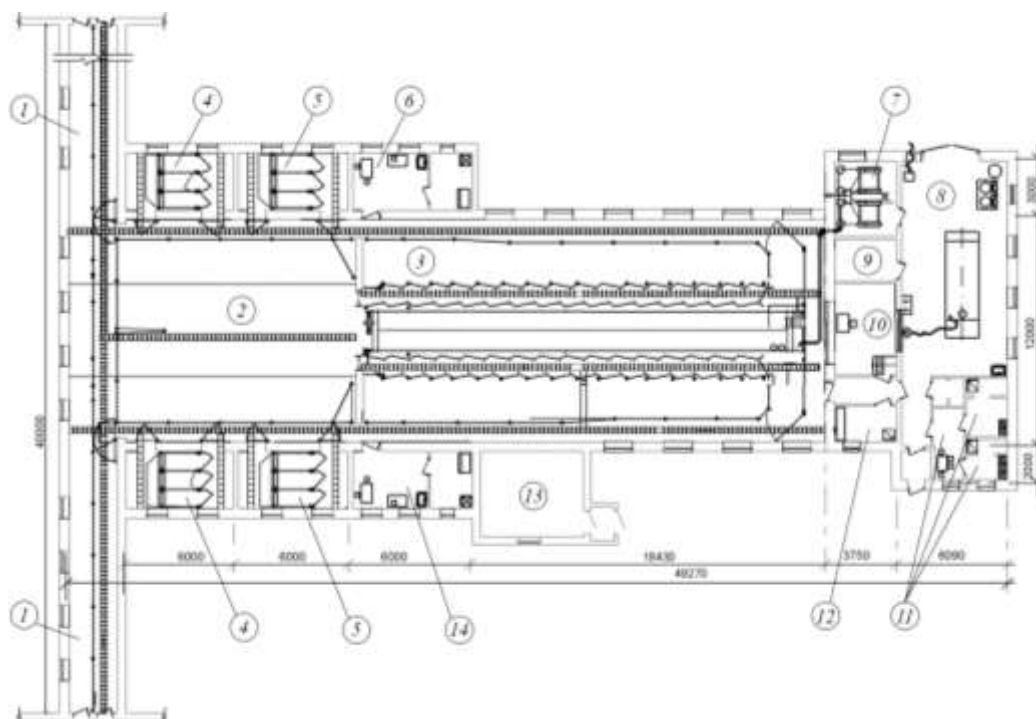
План доильно-молочного блока с установкой доильной УДМ-32Е:
